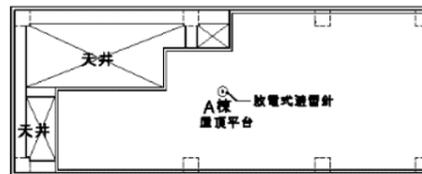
A 棟屋突一層.B 棟屋突二層平面圖 (S=1:300)
